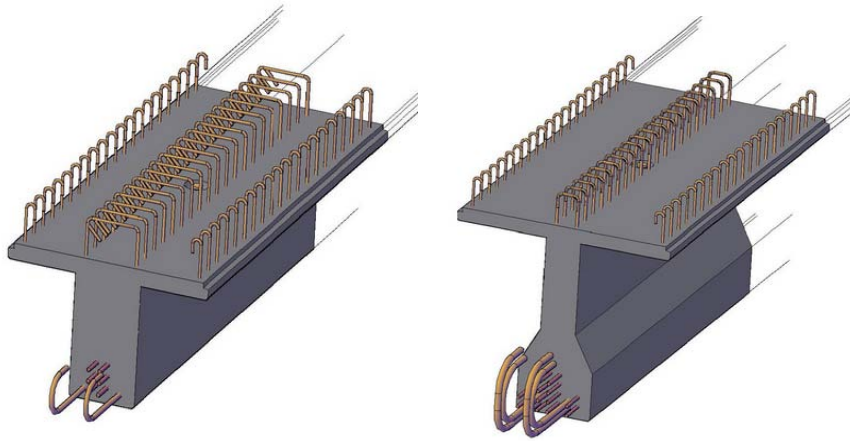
ferrailage poutre (about + médiane )
